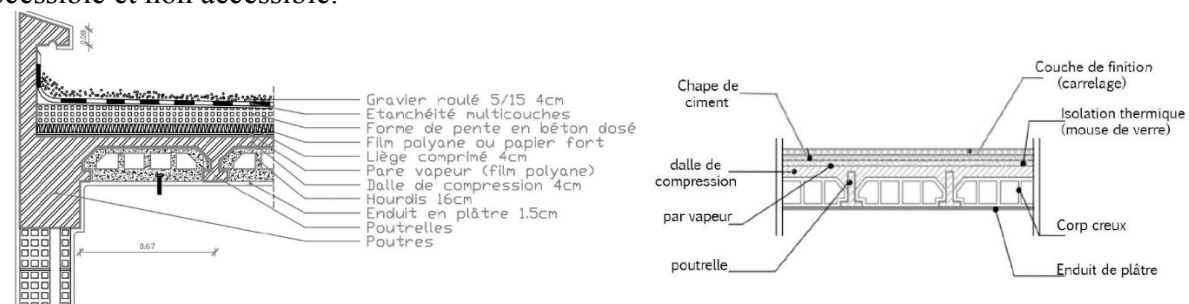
Coupe détaillée sur une dalle /toit accessible et non accessible. Source : (Latreche, 2019)
